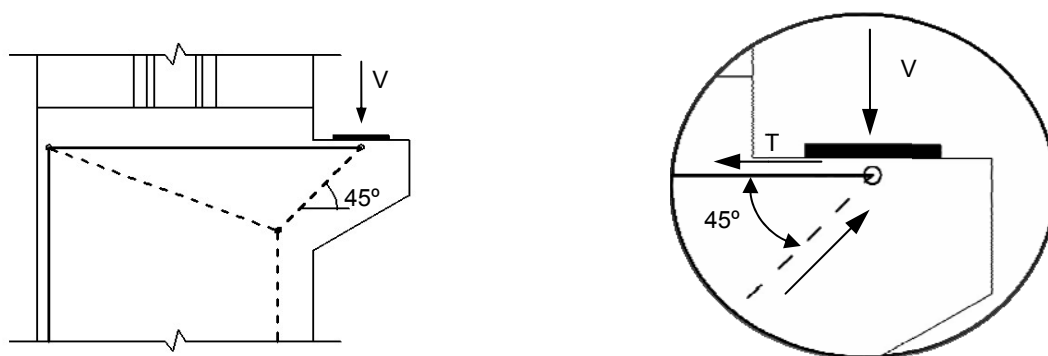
Método das escoras e tirantes aplicado ao cachorro do pilar
